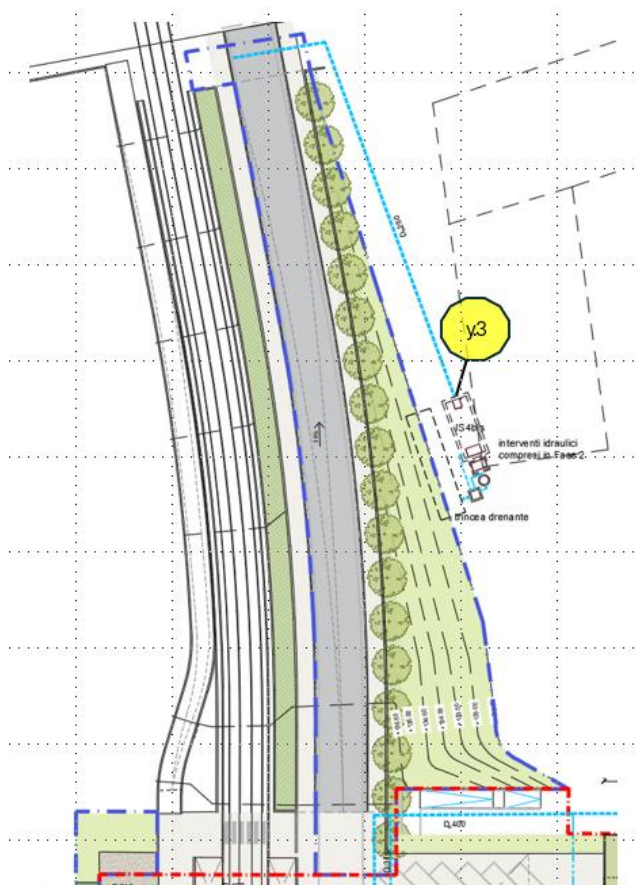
Stralcio planimetrico con sezioni di verifica
